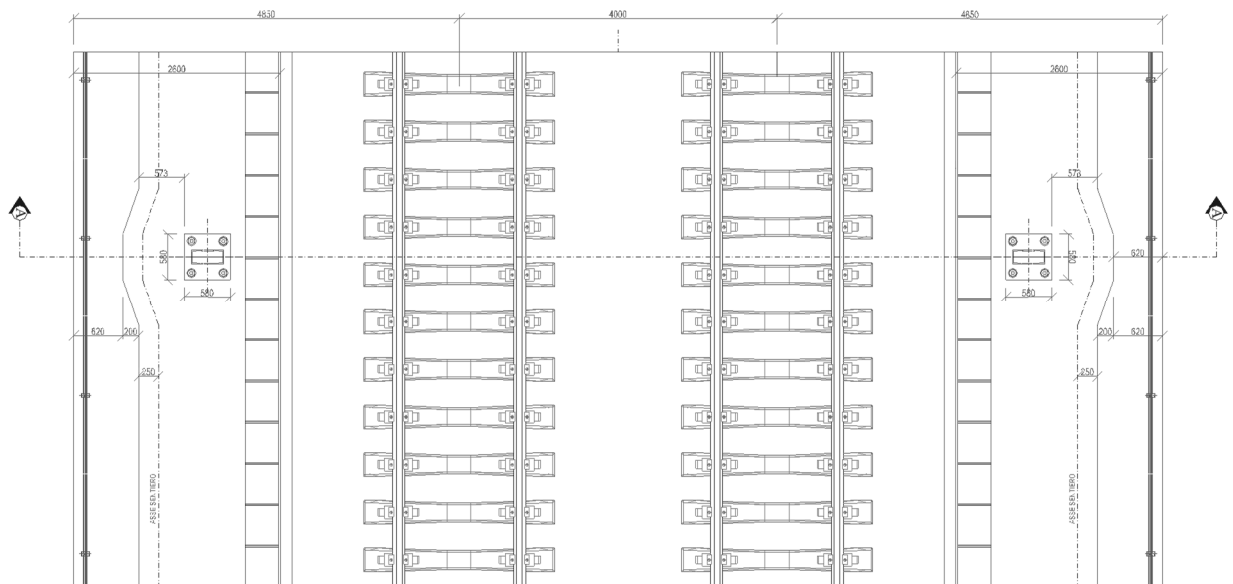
Stralcio planimetrico sezione tipo ferroviaria in viadotto a doppio binario
